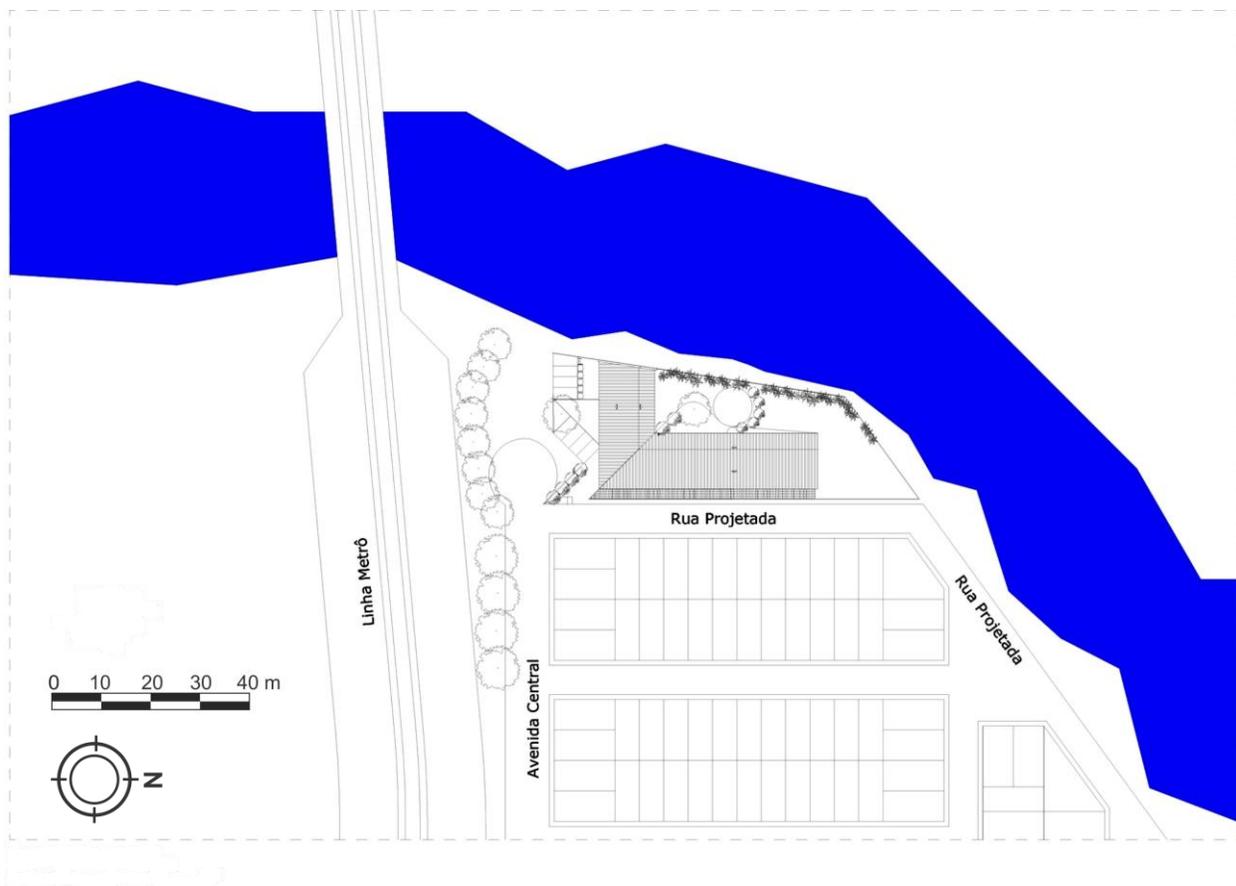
Escola Novo Mangue - Planta de situação.
